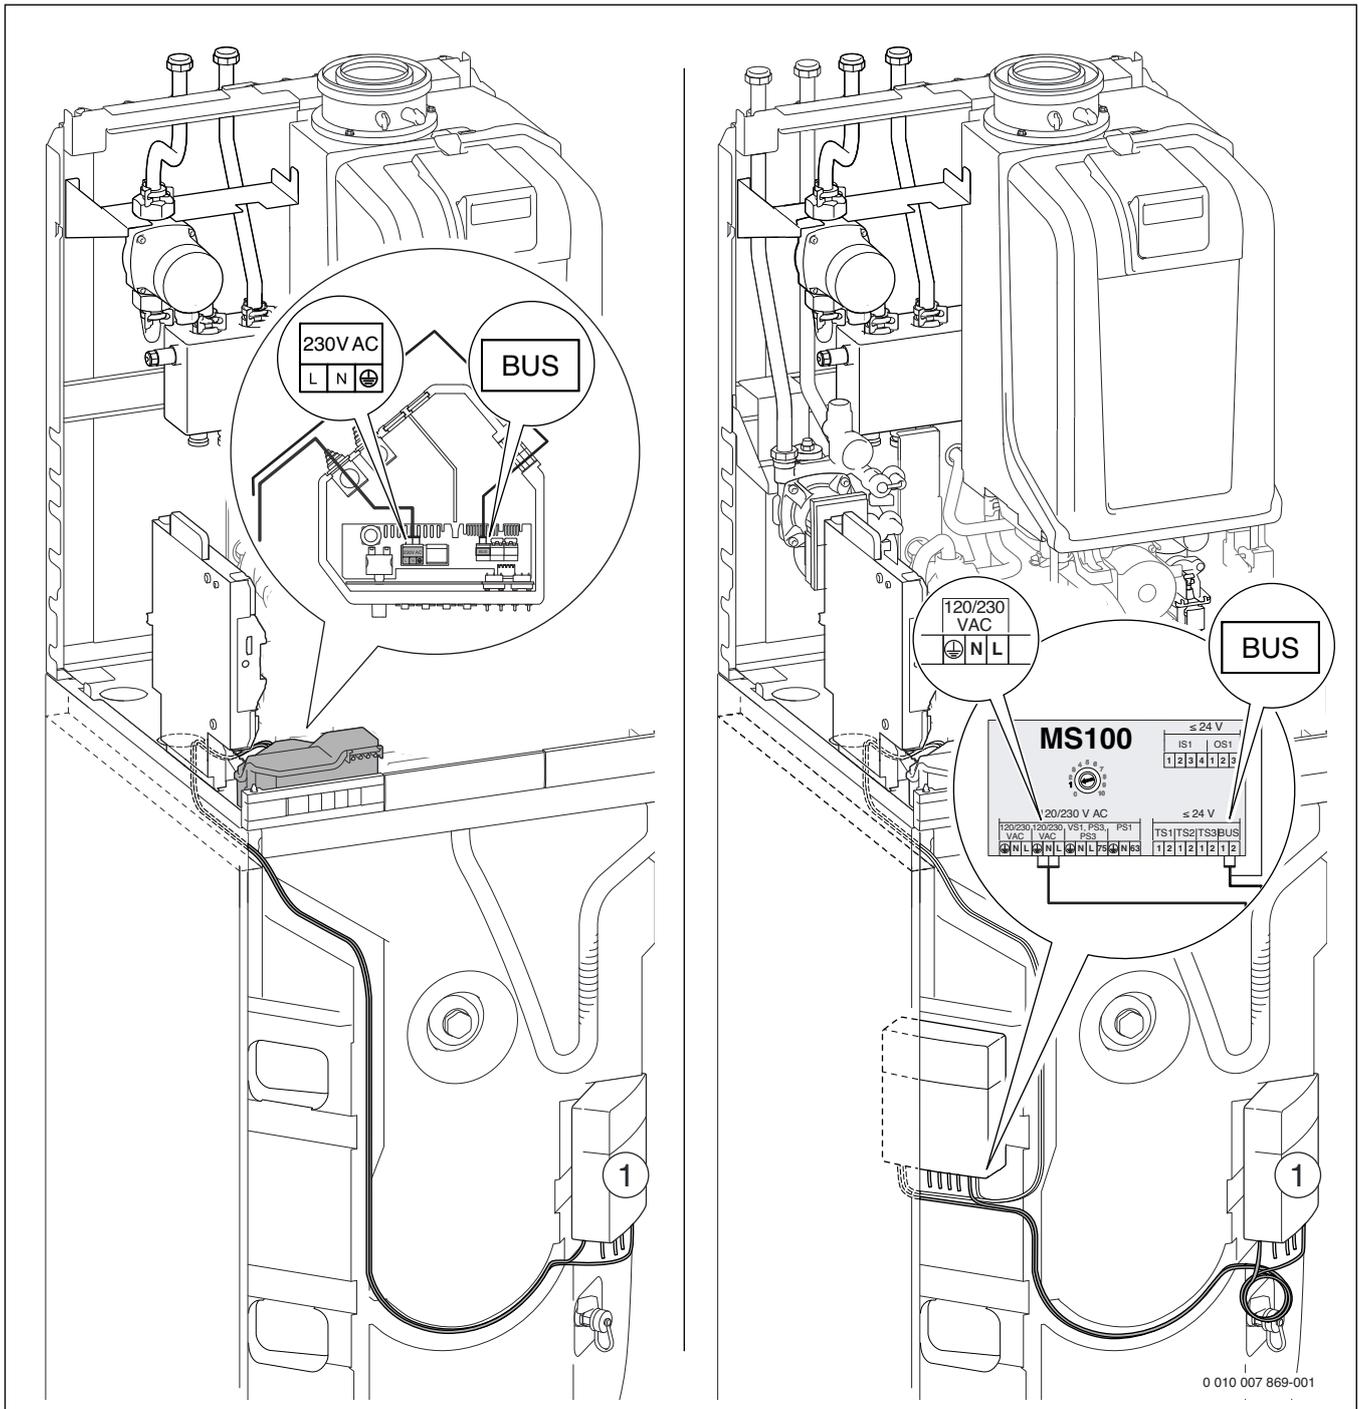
Anschluss ohne Modul MS100 (links) und mit Modul MS100 (rechts)
